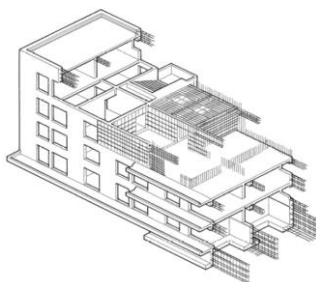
Exemplo de estrutura de parede de concreto armado
